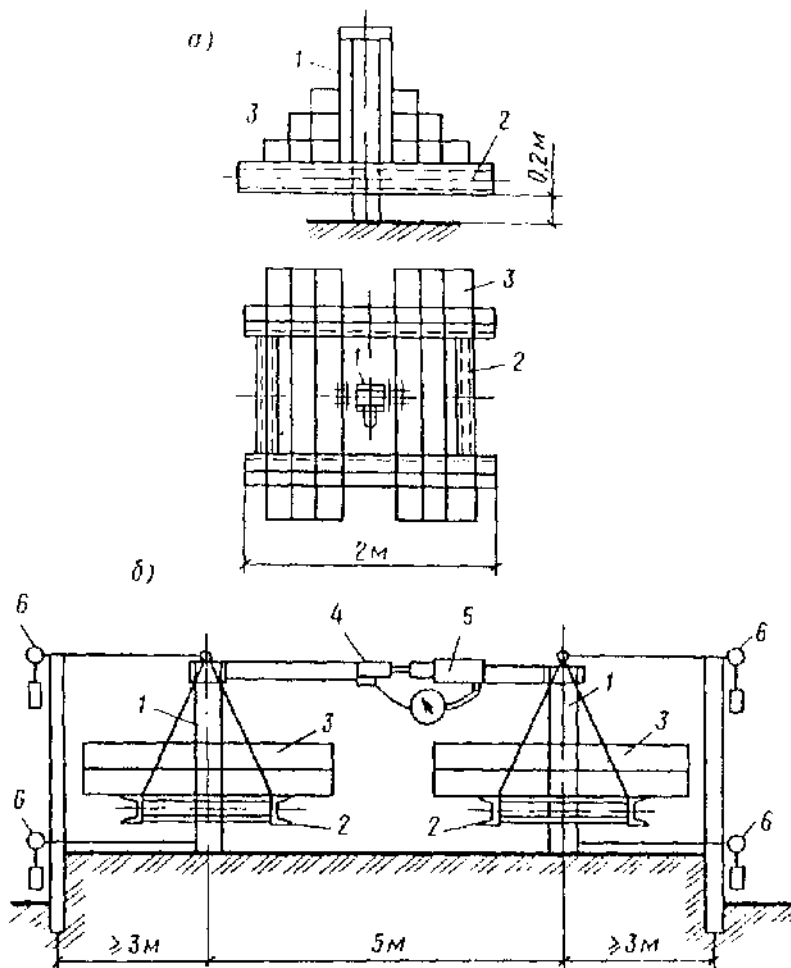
Схемы загрузки свай: а – на вертикальную нагрузку;
